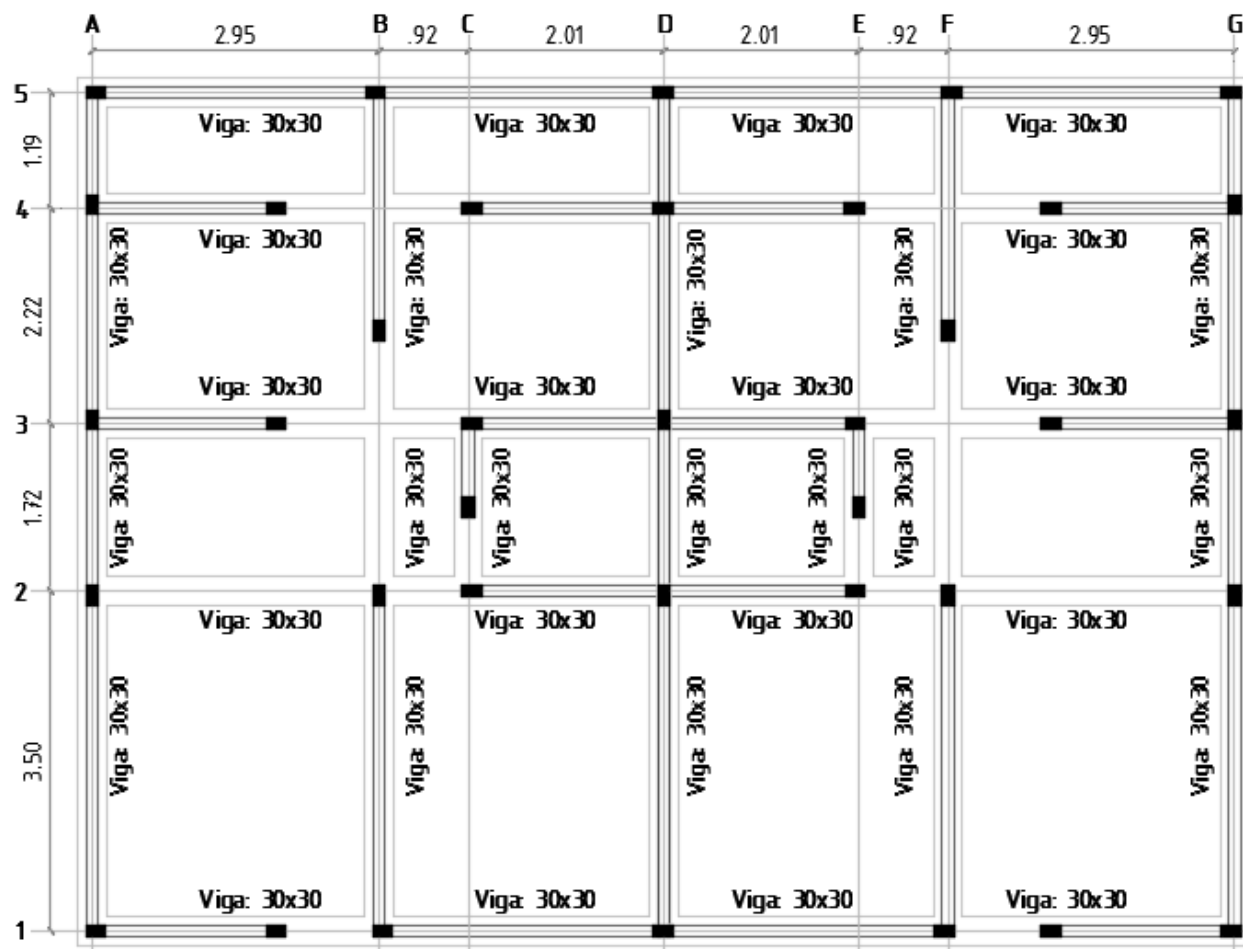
Replanteo estructural muros de mampostería confinada, segundo piso
